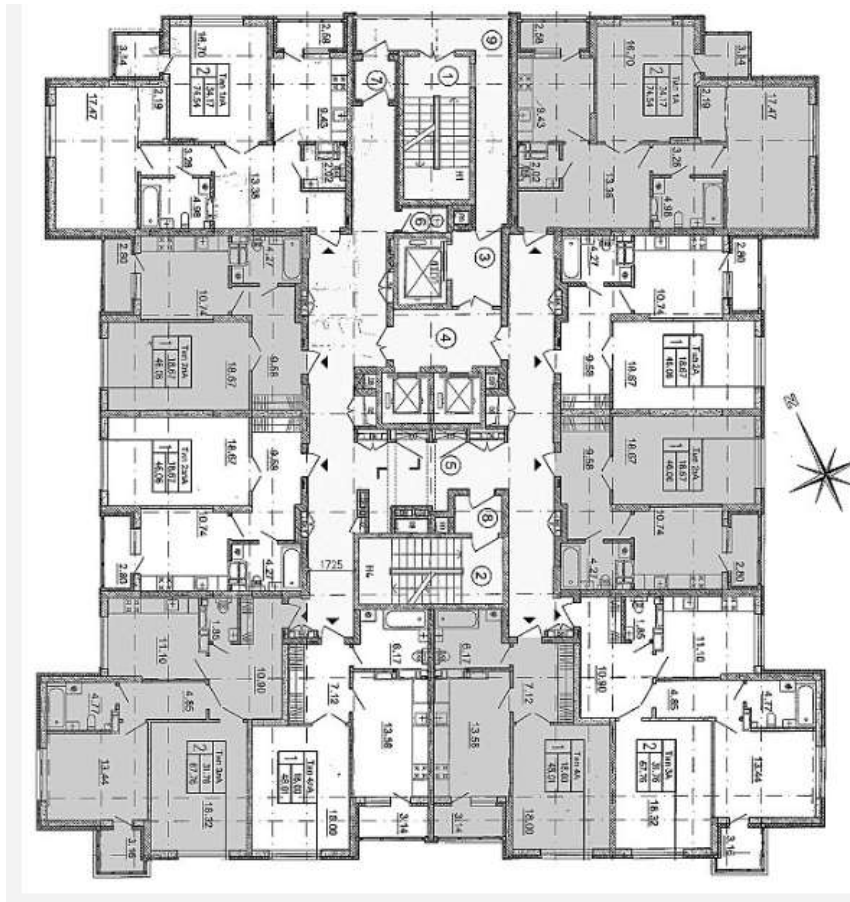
План типового поверху ЖК, Київ, вул. Краківська 27, 2017 р. [10]
